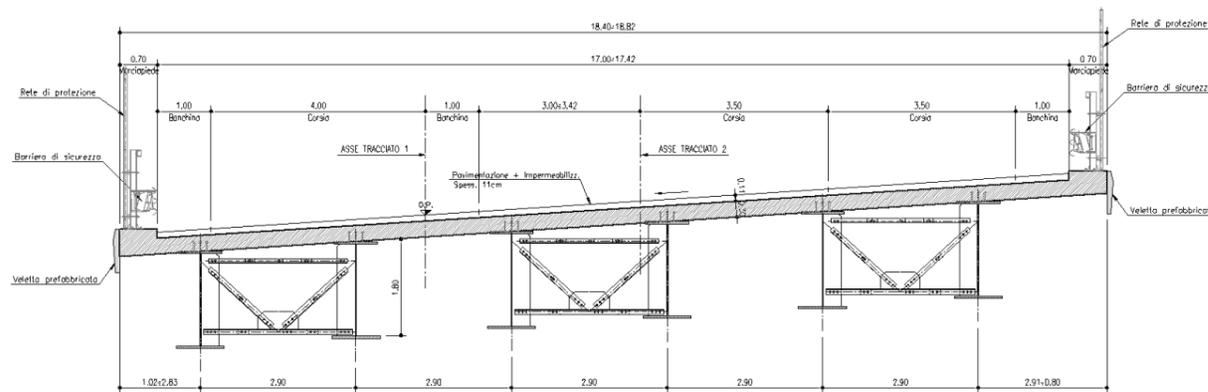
Sezione dell'impalcato Cavalcavia sull'Autostrada A4
